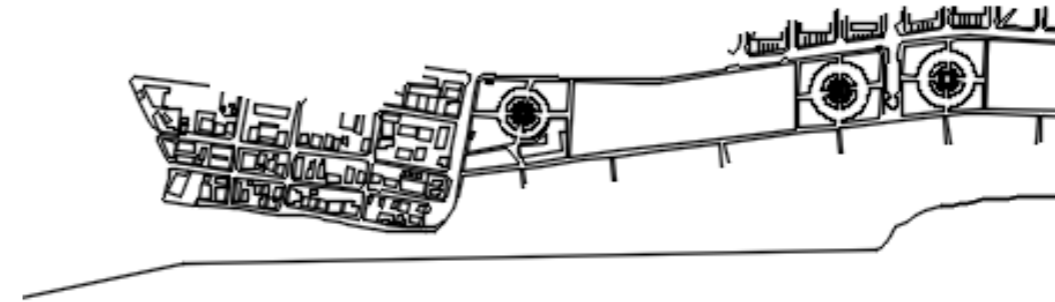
Forma en planta de la alternativa 1: sin estructuras rígidas, de la playa del Mojón. Fuente: Elaboración propia.
